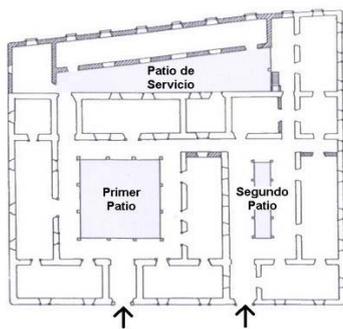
Planta antiga casa de la moneda, Honduras 1889
